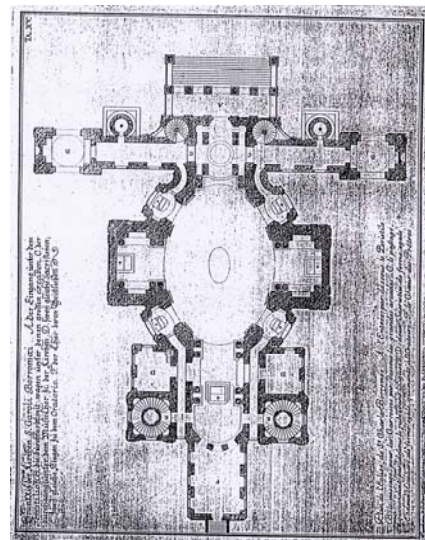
Wien, Karlskirche Grundriss
